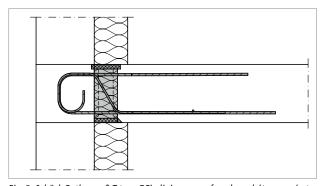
Schöck Rutherma $^{\circ}$ T type DFi : liaison pour façade en béton armé et dalle en béton coulé sur place
